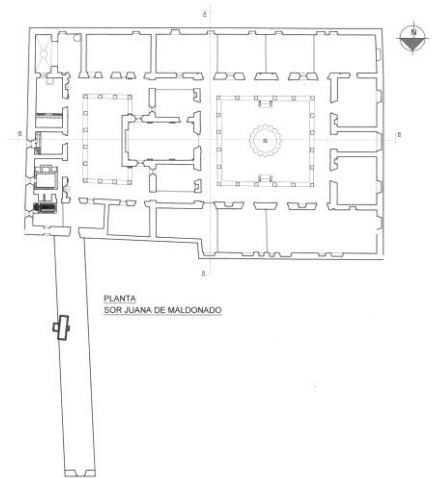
Planta del Claustro de Sor Juana de Maldonado y Paz
